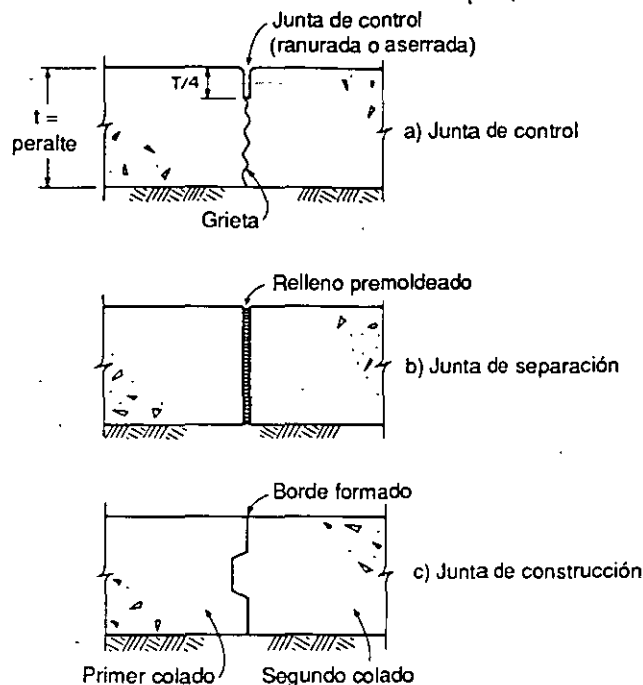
Los tres tipos básicos de juntas empleadas en la construcción de losas de concreto para pavimentos.
